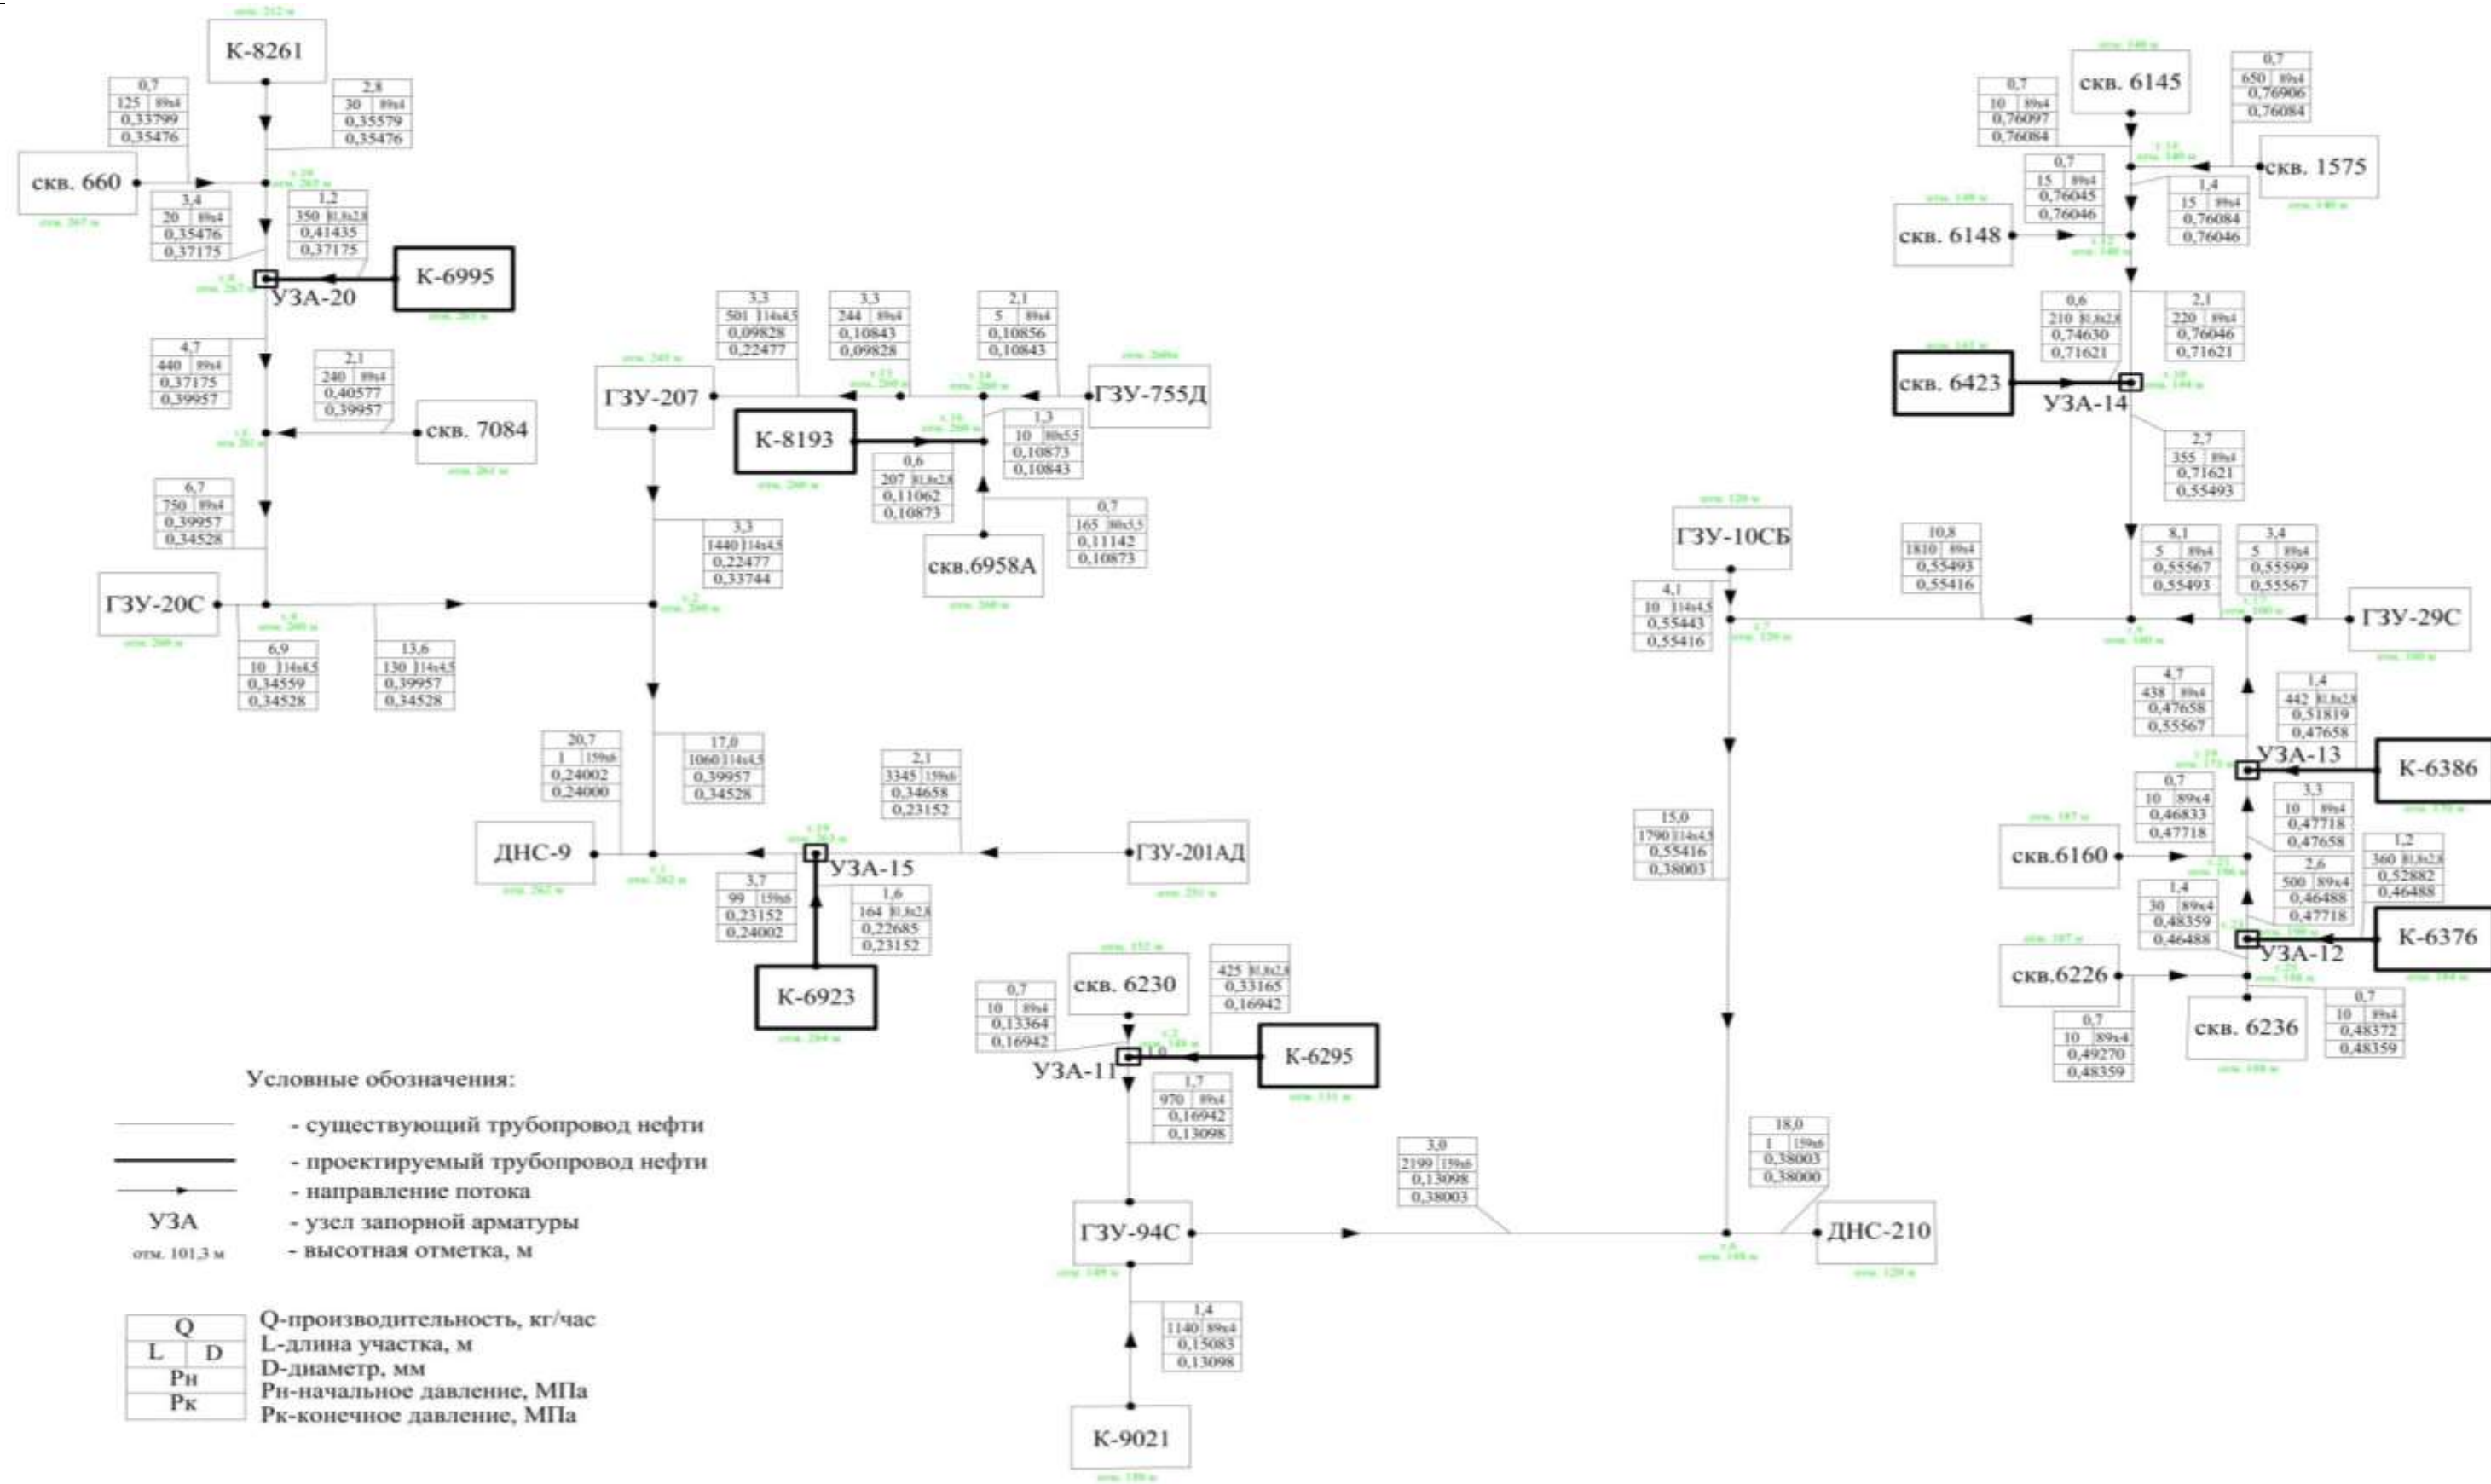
Расчетная схема нефтегазосборных трубопроводов площадки развития К-6995, К-6923, К-8193, К-6295, К-6423, К-6386, К-6376
